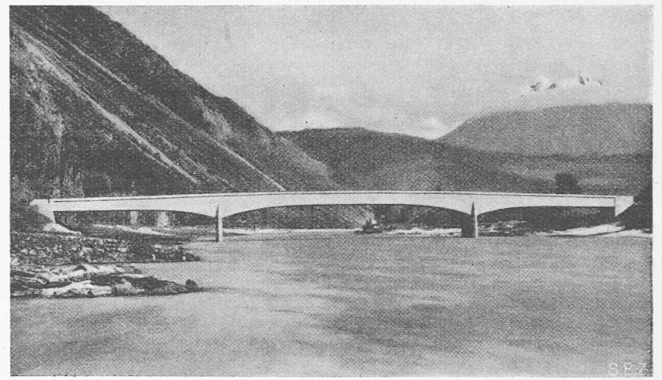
Rechteckbalken, Spannweite Mittelöffnung 45 m
